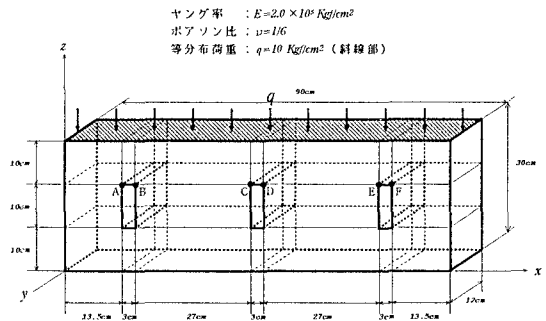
コンクリート布基礎構造物（孔が長方形の場合）
